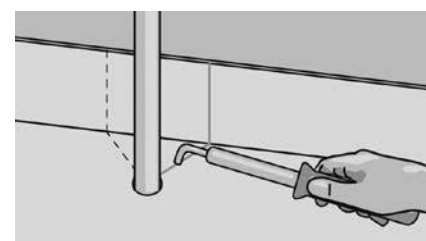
При укладке напольного покрытия вокруг труб рядом со стенами, надрежьте покрытие и прижмите его к трубе, чтобы сформировать «воротник». Если расстояние между трубой и стеной маленькое, сделайте надрез так, чтобы потом осталась возможность его сварить. Т.е. качество сварки и последующая функциональность имеют приоритет над эстетическим внешним видом. Если нужно сделать обшивку, вам необходимо:
